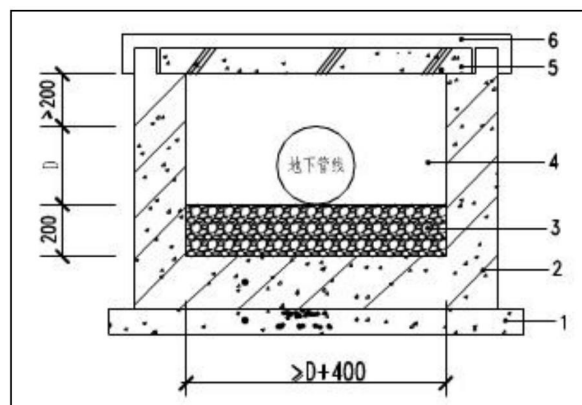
抗渗钢筋混凝土管沟防渗层示意图
